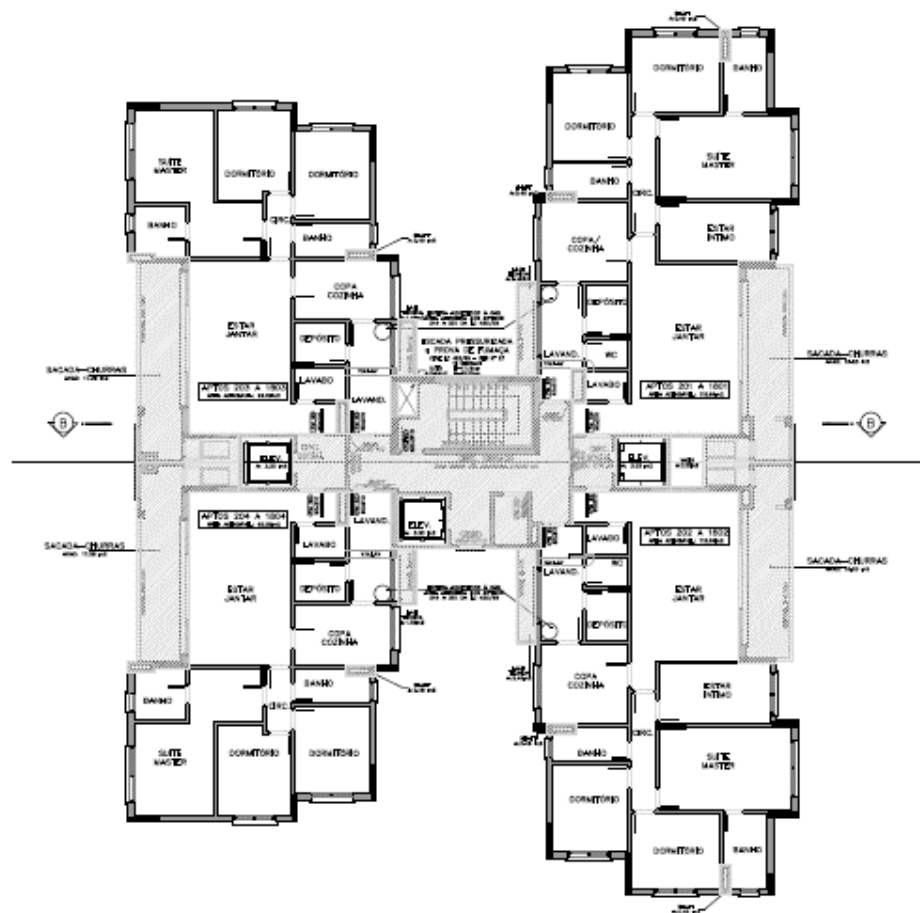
Planta baixa parcial do pavimento-tipo da Torre C do Condomínio Cipriani
